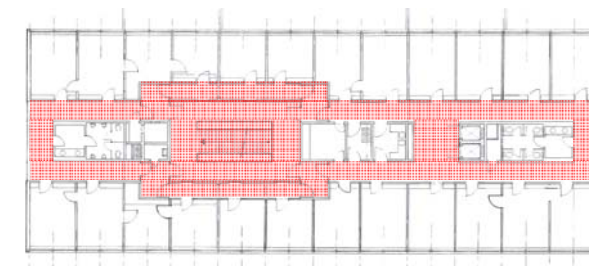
Regelgeschoss - Grundriss 2.OG
